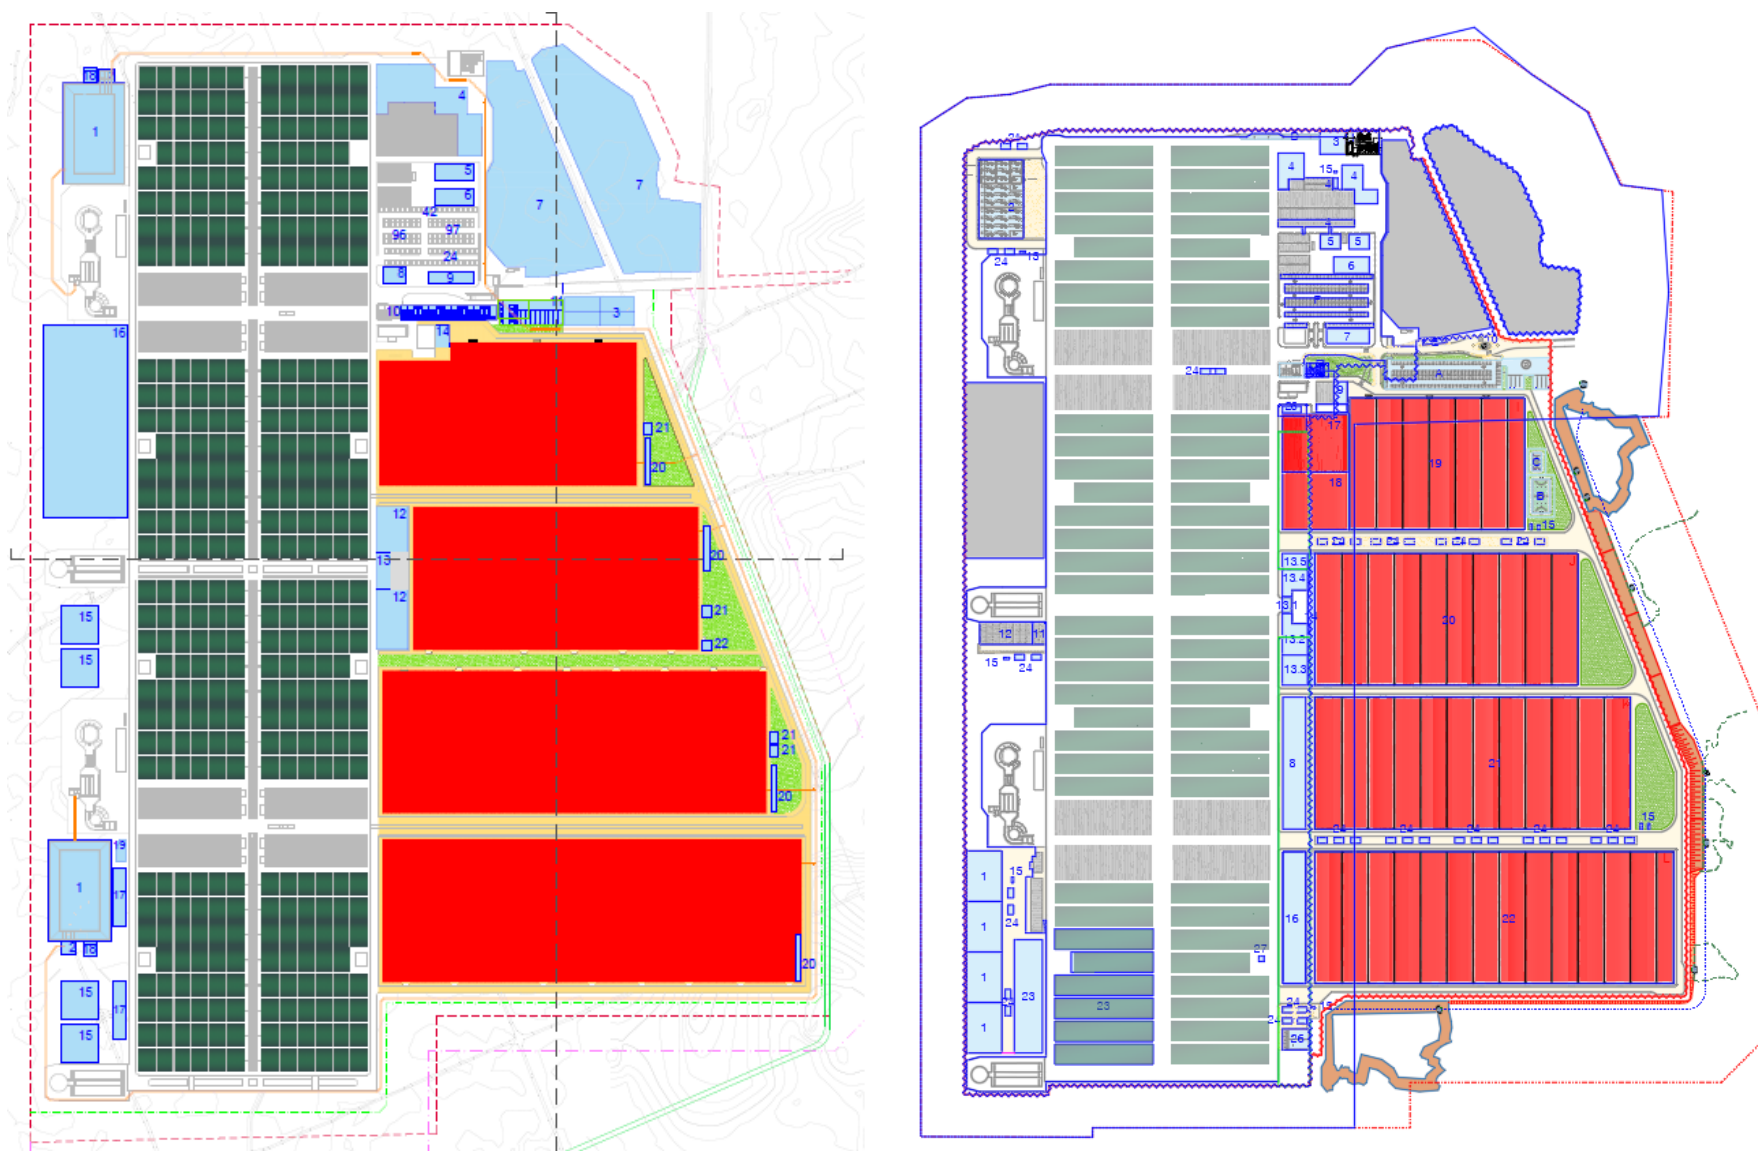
Alterações no desenvolvimento do Estudo Prévio e Projeto de Execução (A: Planta geral do Estudo Prévio; B: Planta geral do Projeto de Execução)
